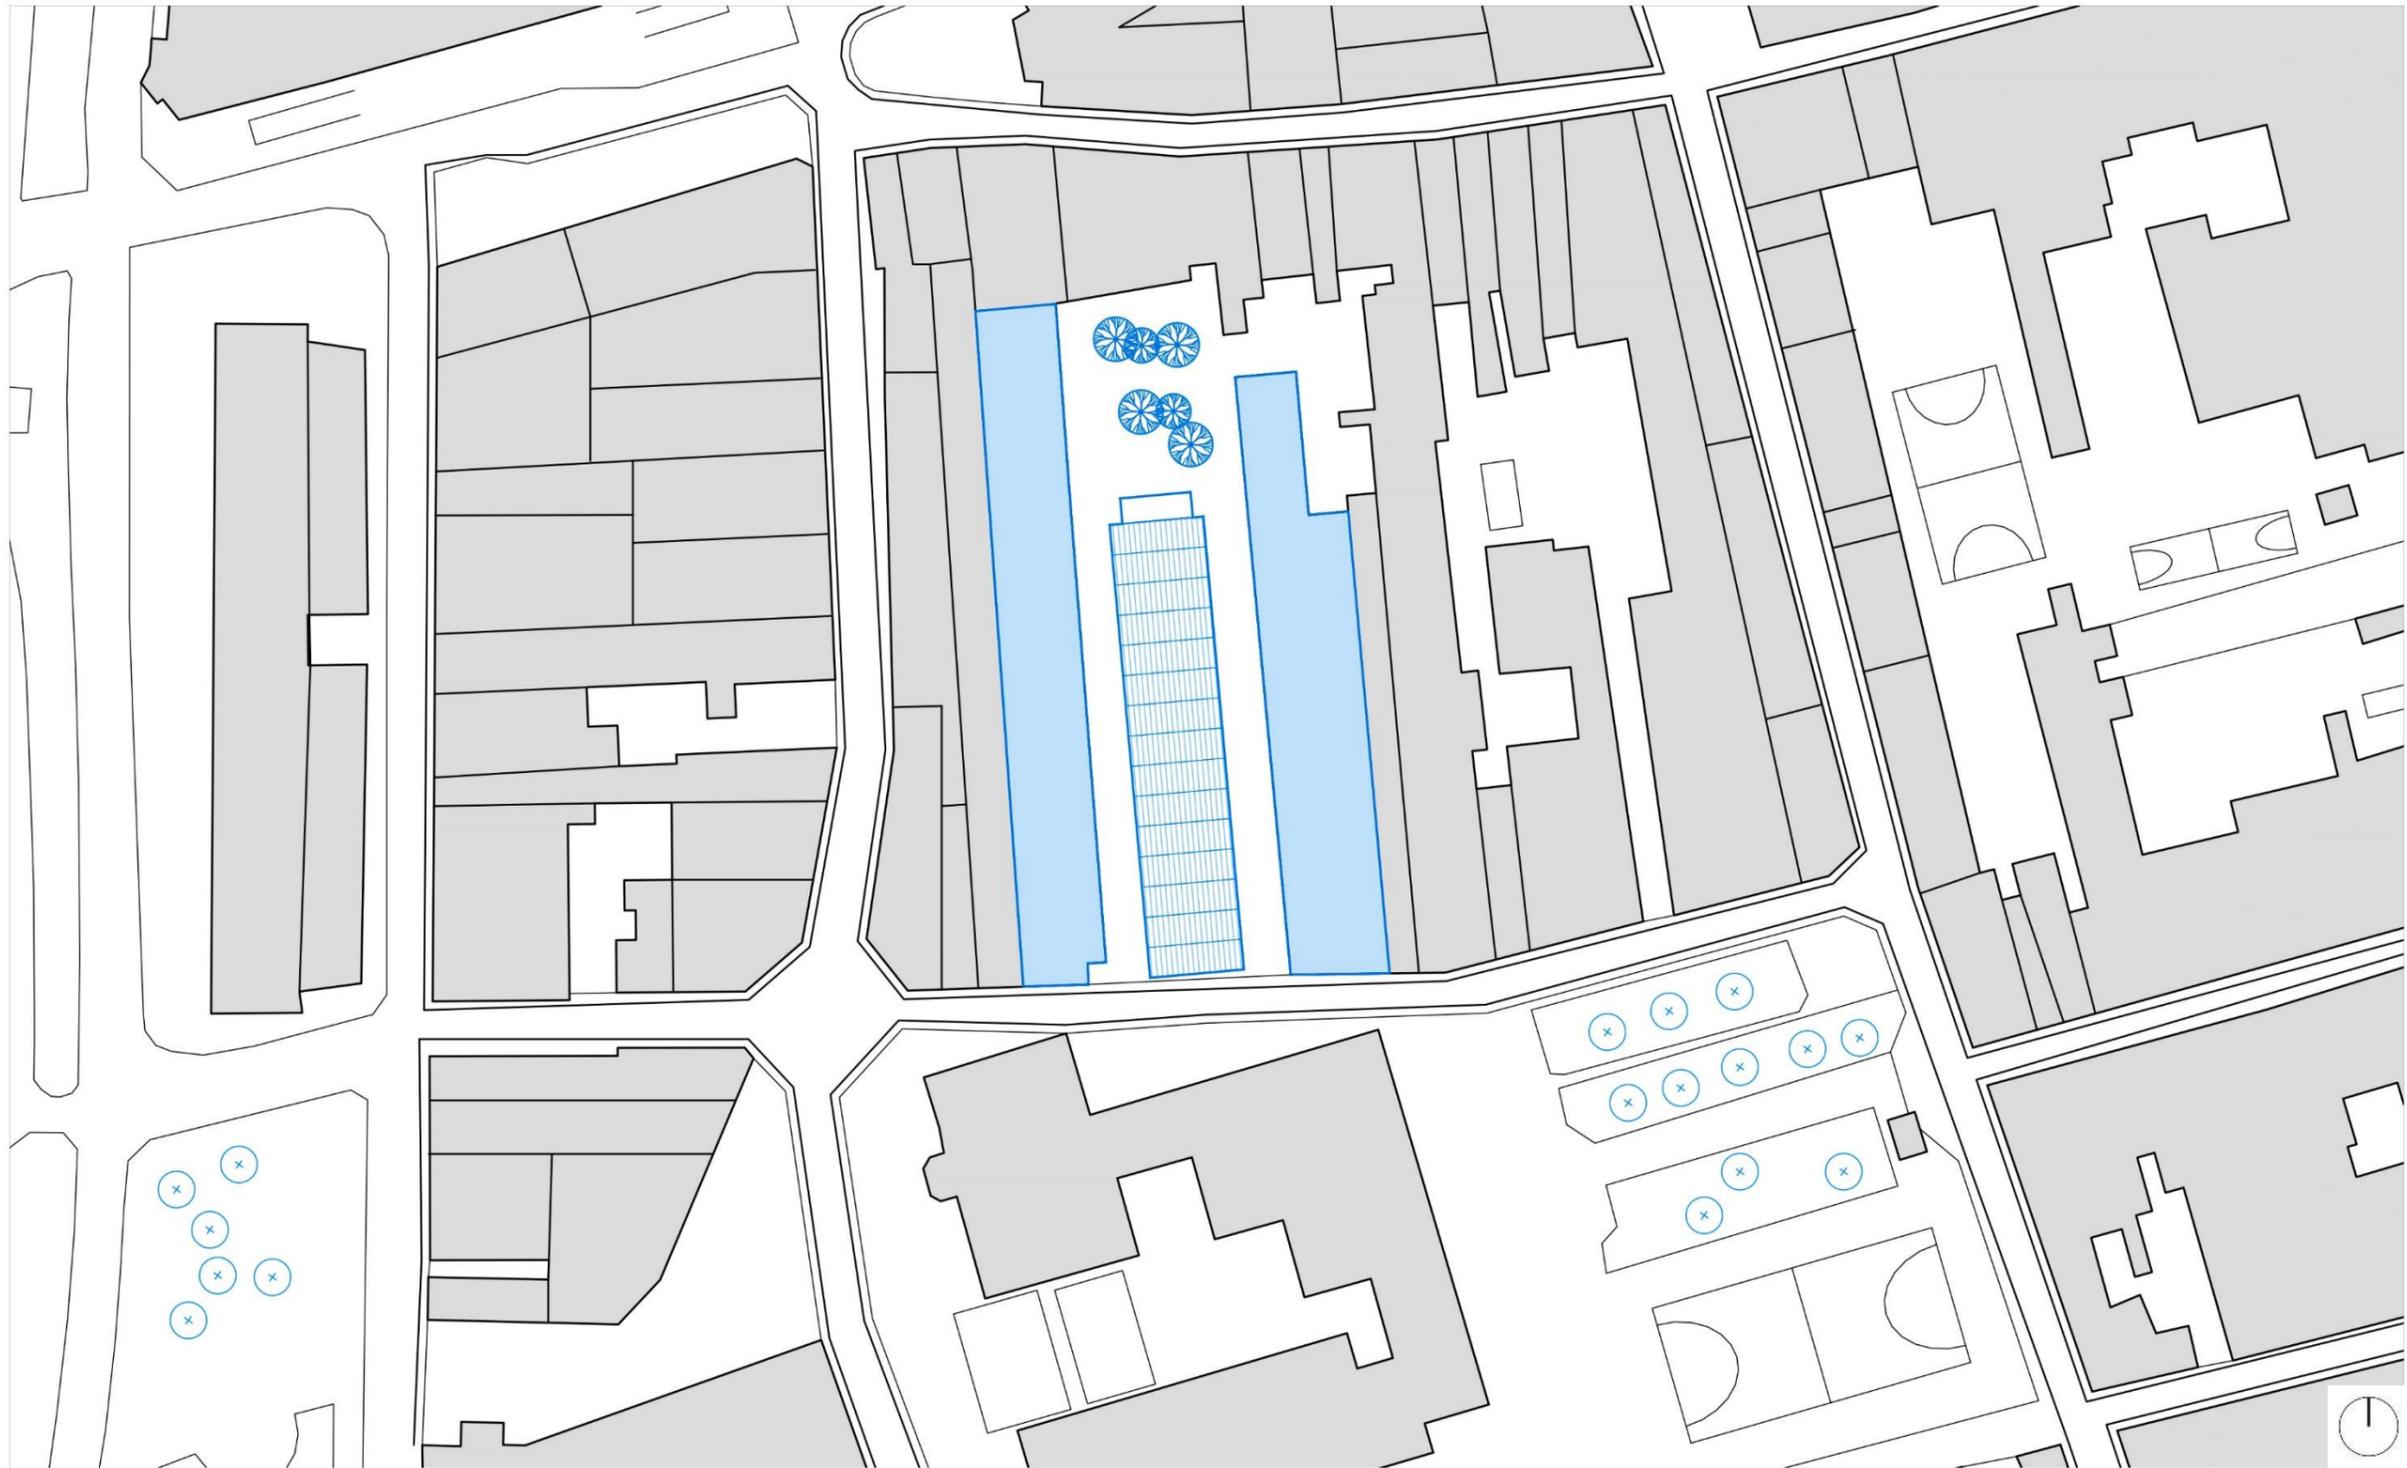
PLANO 1/1000. Plano general intervenció fàbrica Pere Can Batallé.
